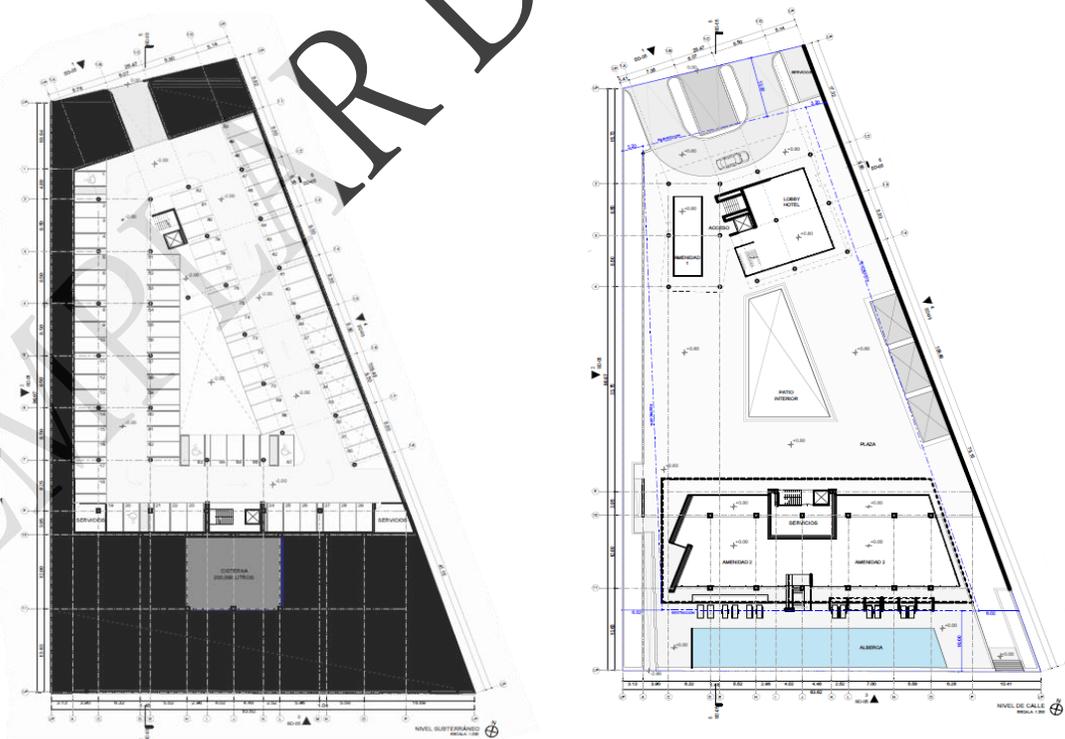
Plantas arquitectónicas de subsuelo y nivel calle
